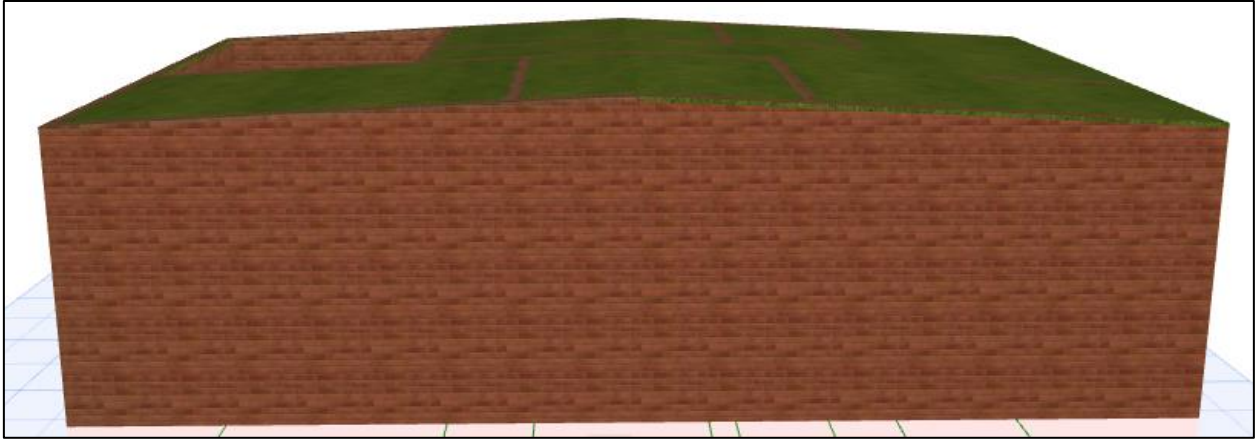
Diseño de modelo de vivienda “VIS” con cubierta verde extensiva fachada lateral. Fuente: Elaboración propia.
